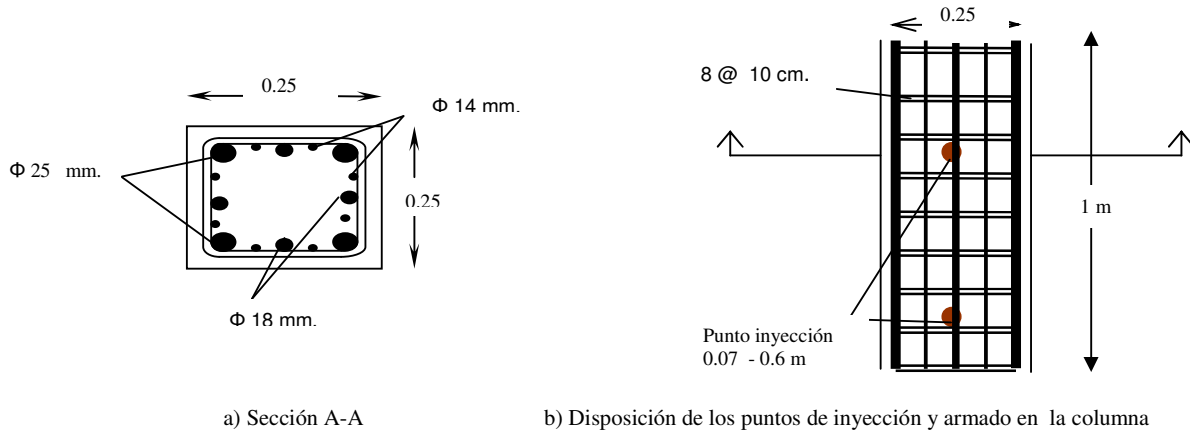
Armado de una columna y puntos de inyección para la inyección del grout
